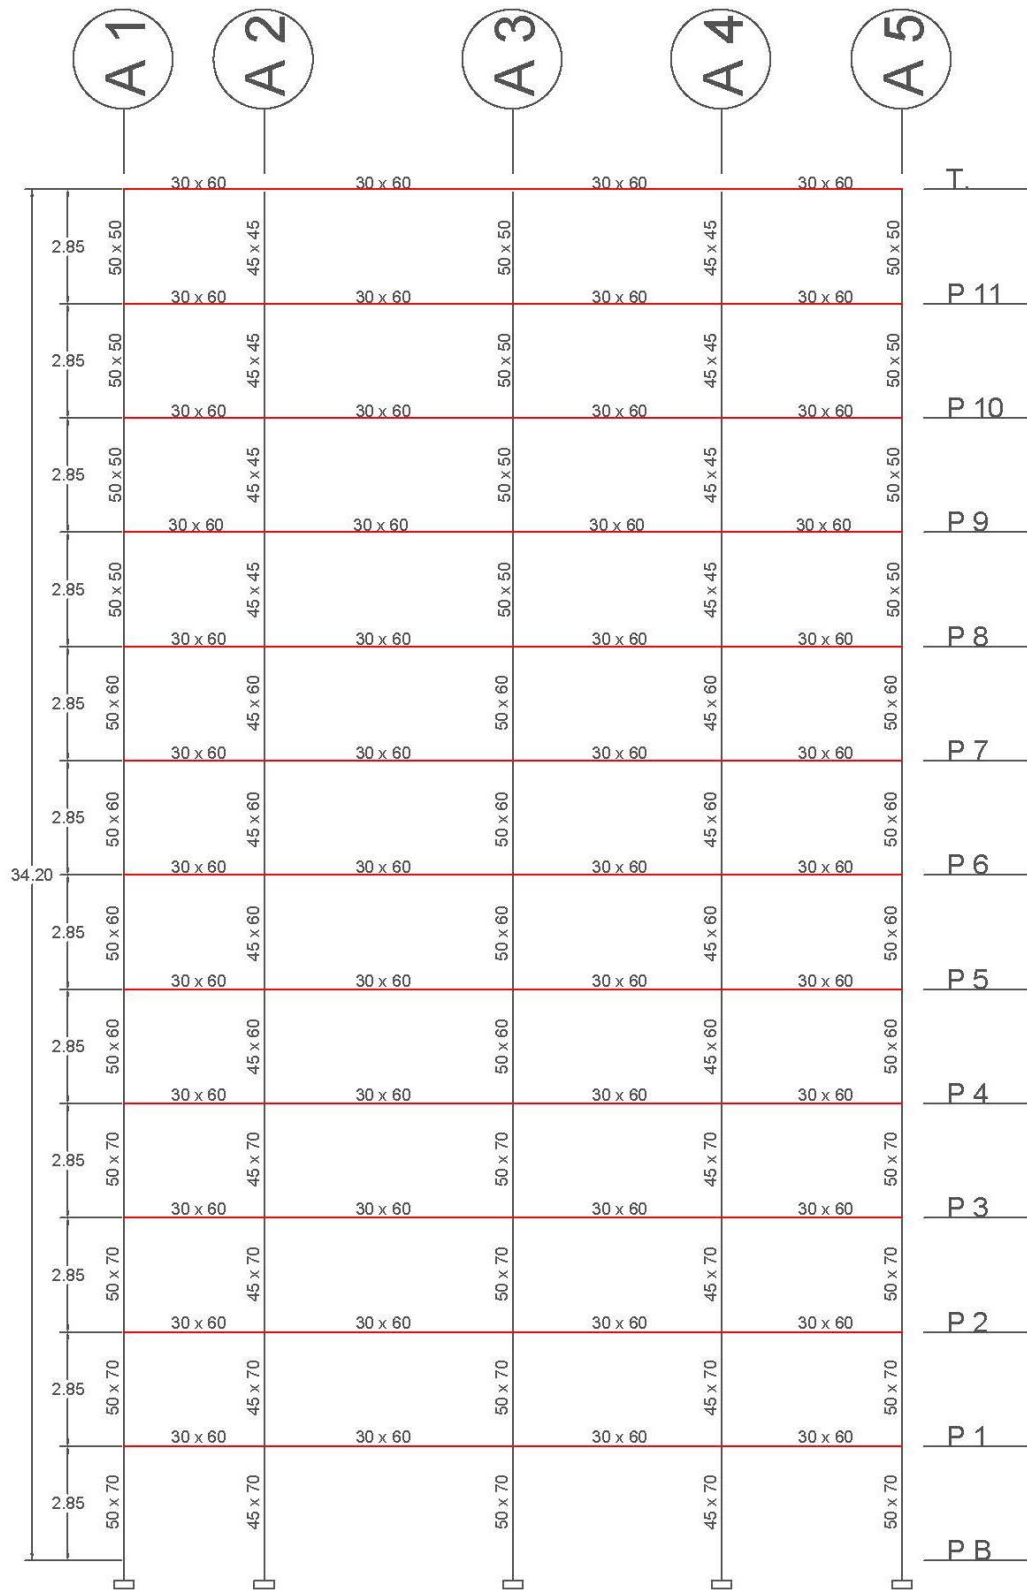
ELEVACIÓN PÓRTICO A Y F
